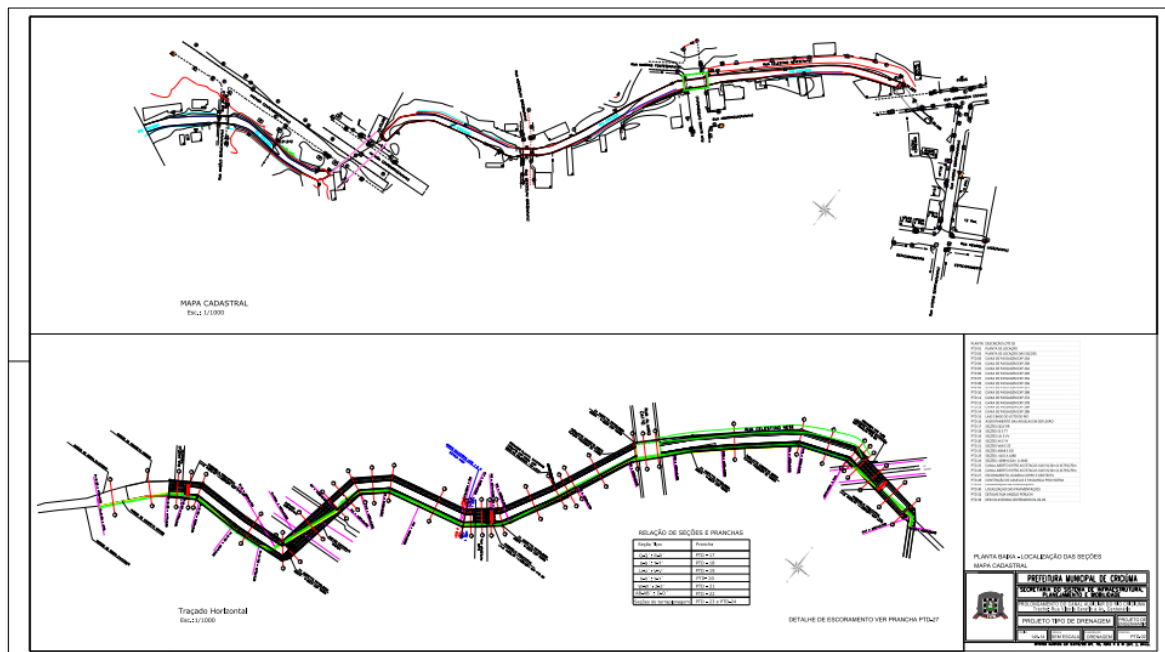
Planta baixa localização das seções. (Fonte: PMC)
